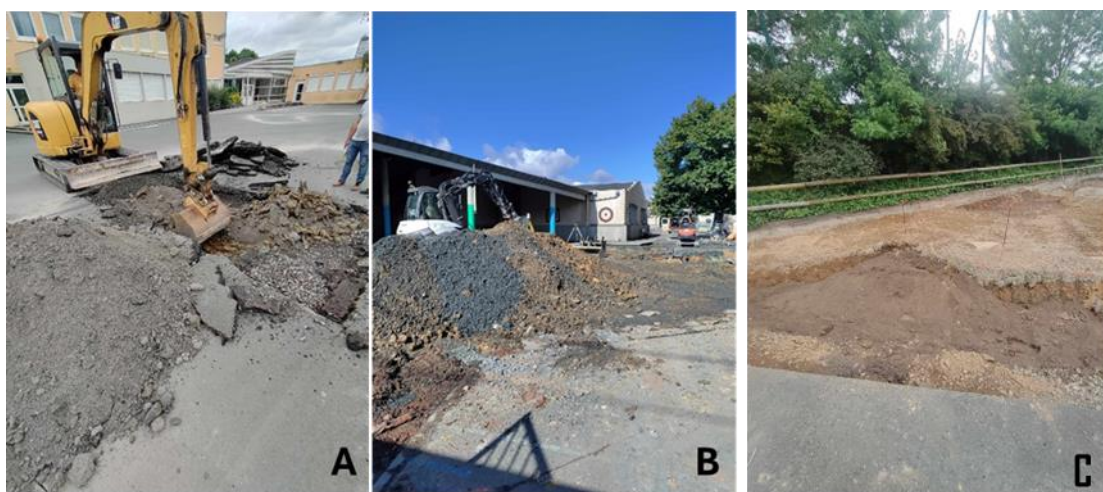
Excavations à la pelle mécanique des matériaux sous la couche d'enrobé. Réutilisation pour partie sur site dans un cas (A – chantier 4) et purge avec export dans un autre cas (B- chantier 3-B), purge et remblai d'une fosse avec de la terre décapée sur site pour un autre cas (C- chantier 3-A) (©J.LARGUET)
